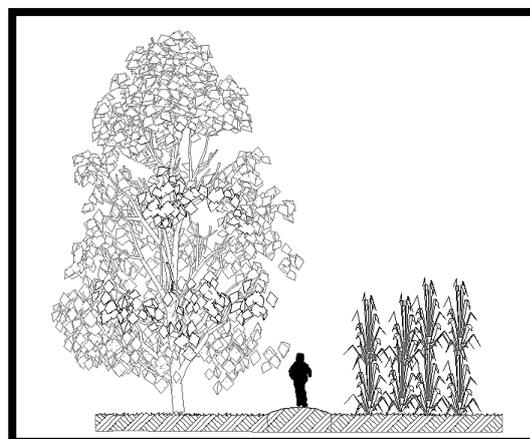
SECCIÓN DE LA CALLE D - TRAMO T9-T16
